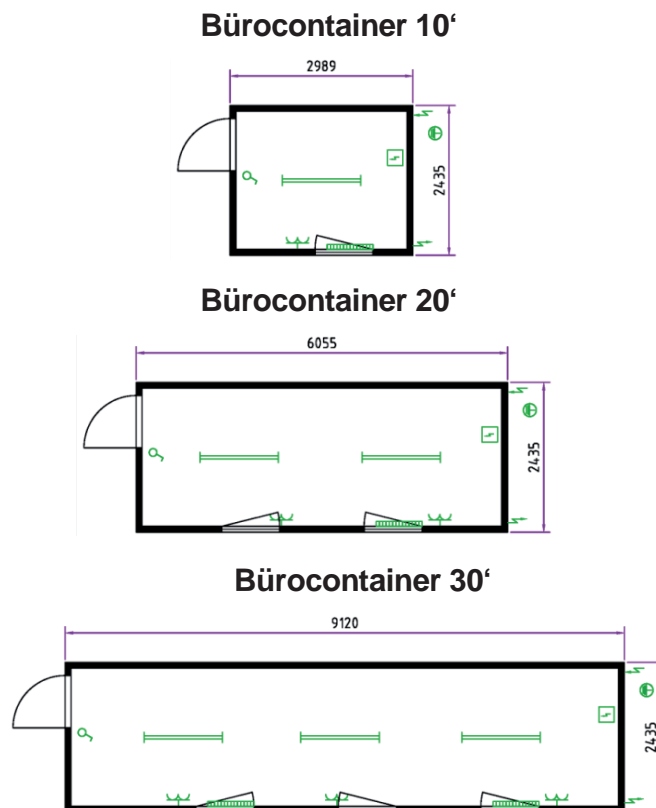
Standardausführungen von Bürocontainern im Grundriss
